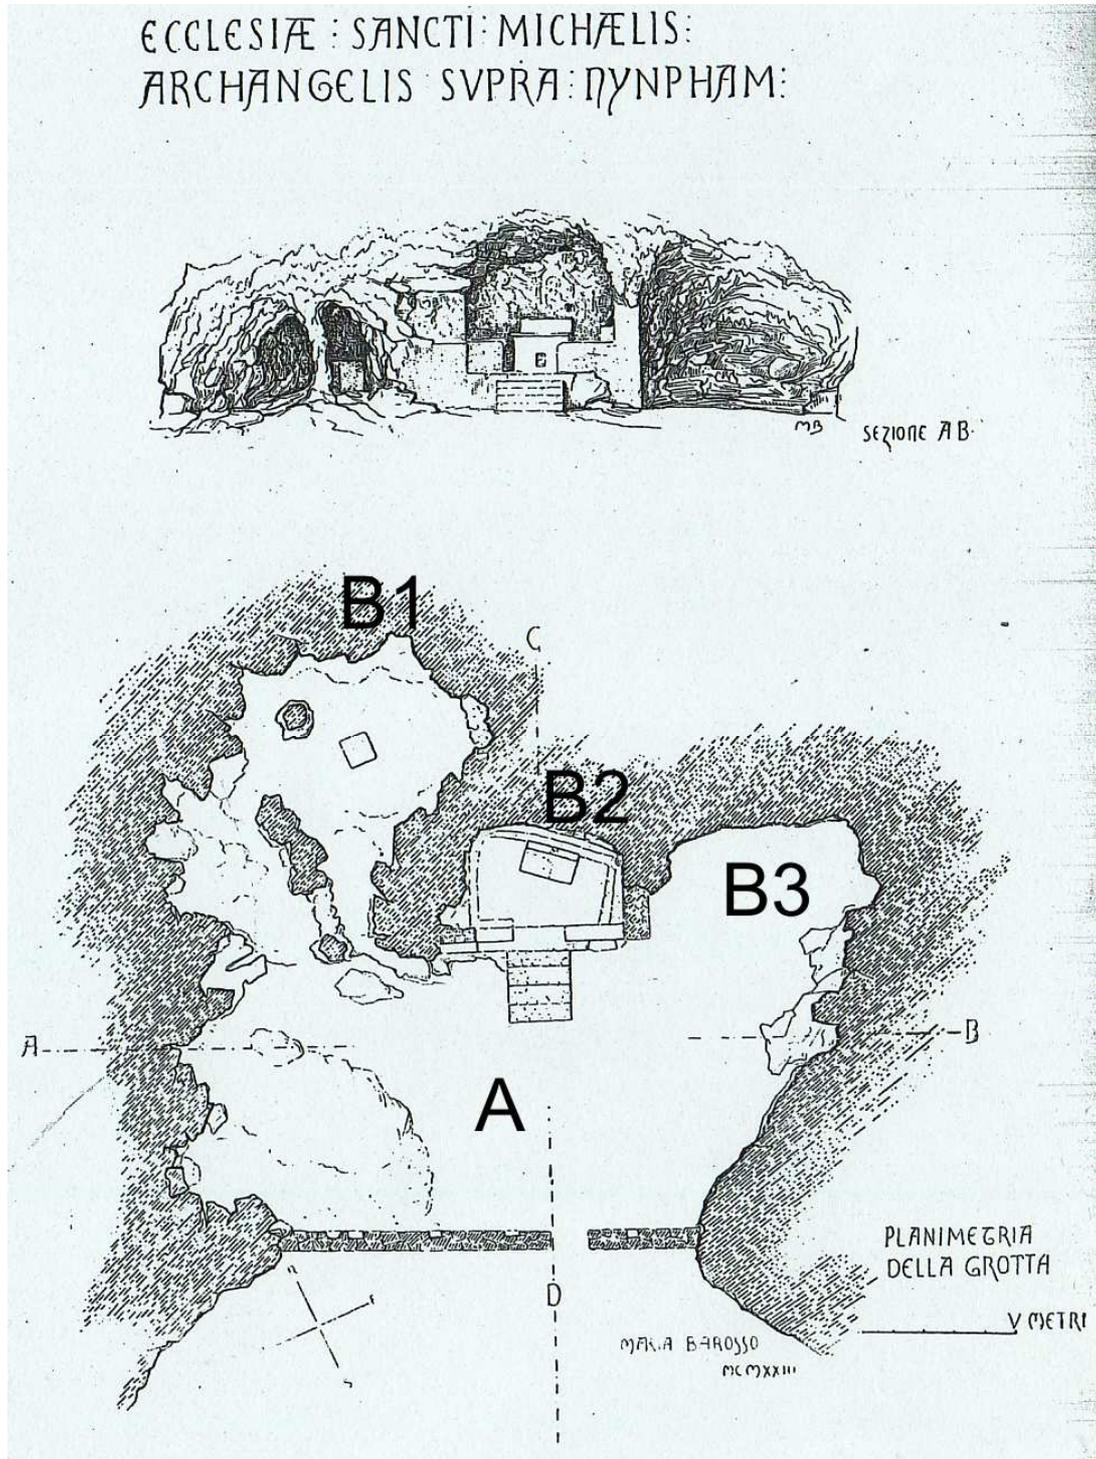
S. Angelo al Mirteto, sezione e planimetria (fonte: Barosso 1938, modificato dall'autore).
